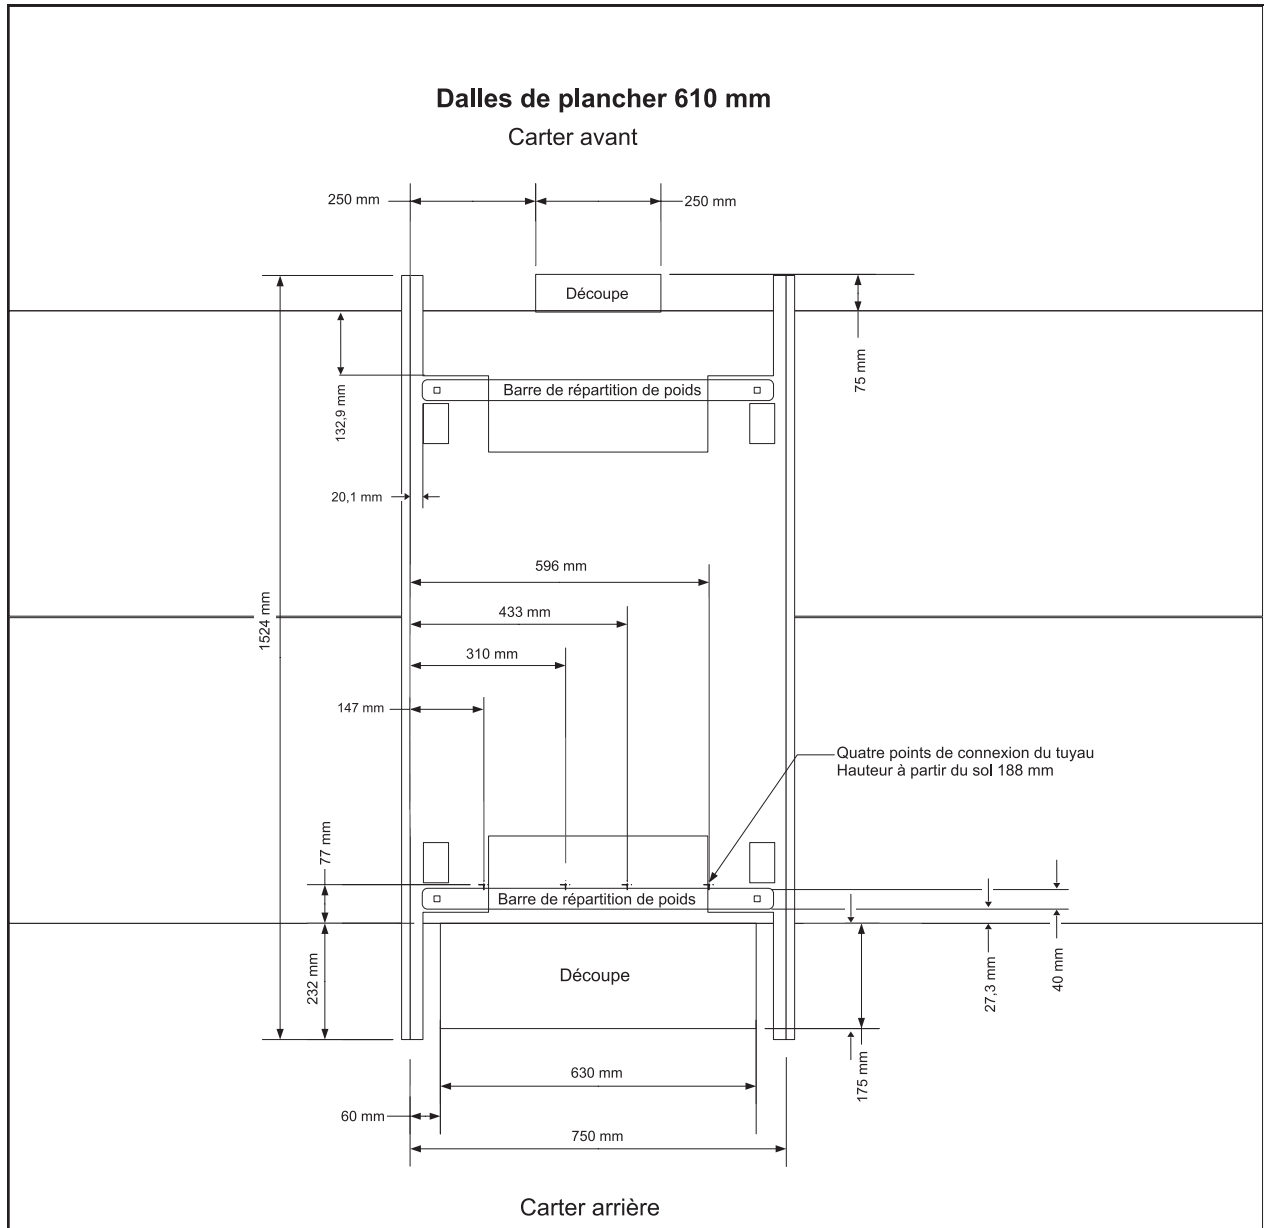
Définition de découpe de dalle de plancher de 610 mm
